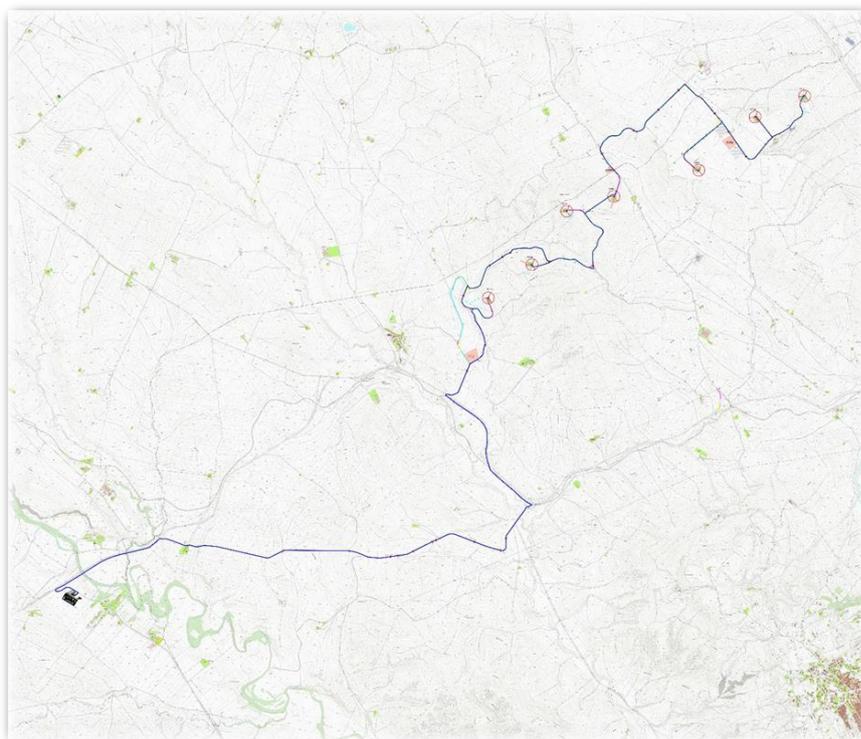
Layout impianto con individuazione del tracciato dell'elettrodotto
